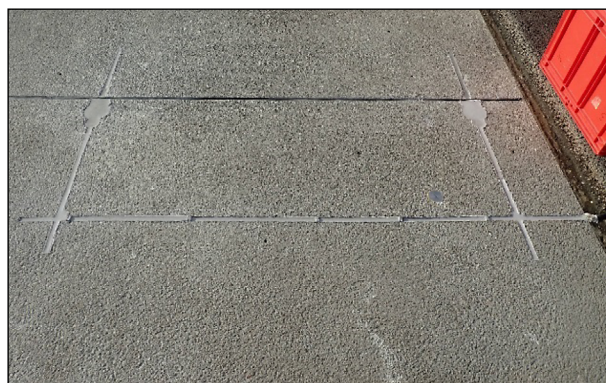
Eingebaute Sensoren 3 R und 3 M auf der Fertigteilbetonstrecke
